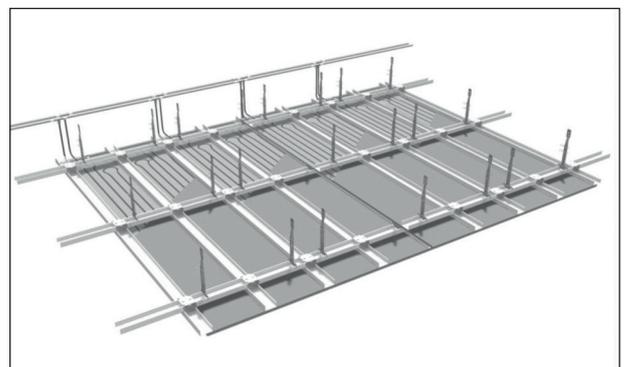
Deckenheizung in Trockenbauplatten auf Metallunterkonstruktion
